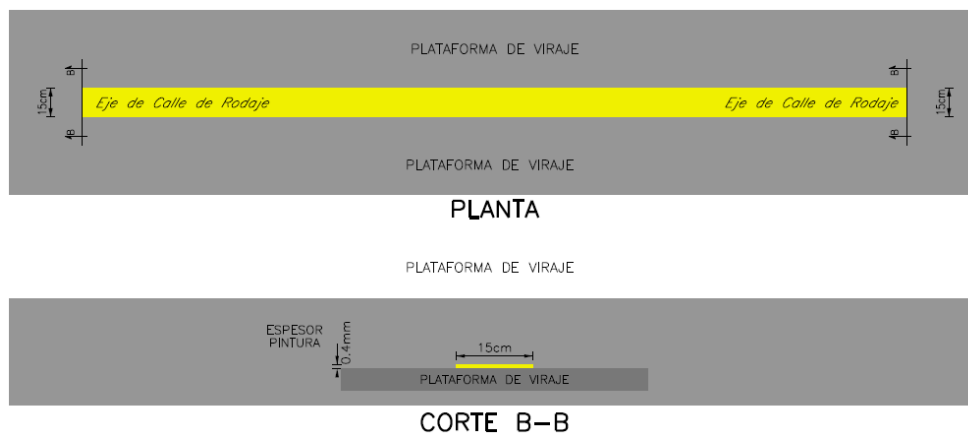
Detalles en planta y corte sobre colocación en pavimento de Señal de Plataforma de Viraje.
